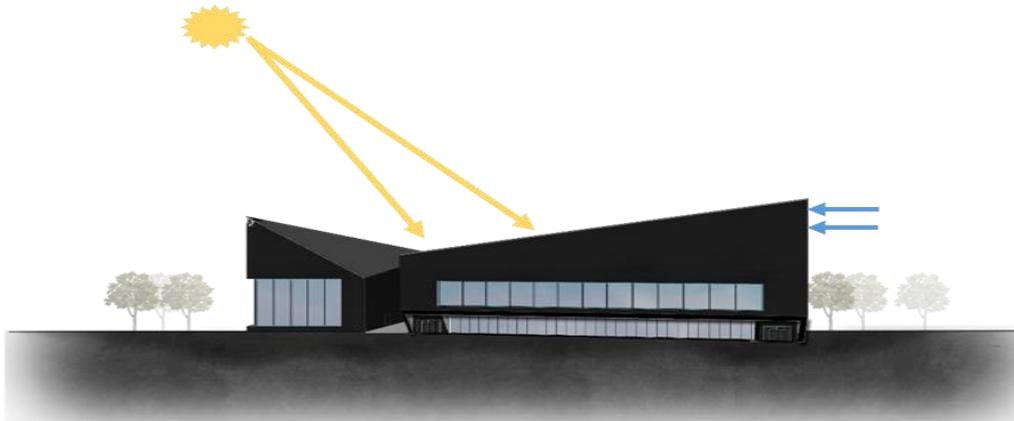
Illustration d'ensoleillement et de ventilation sur la façade EST
